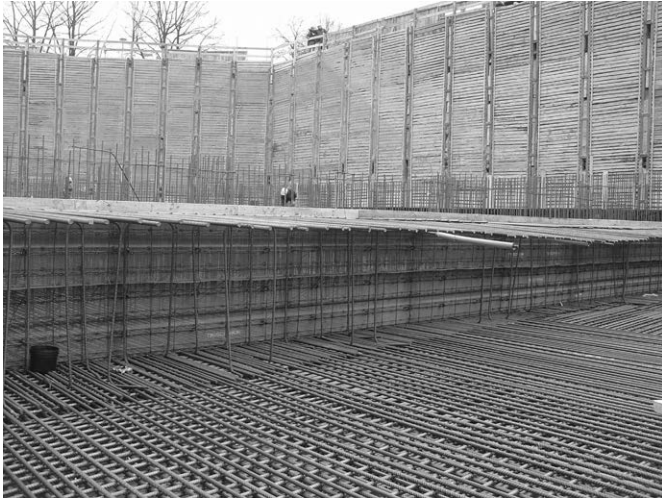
Bewehrung einer massigen Sohle (Foto T. Richter)
